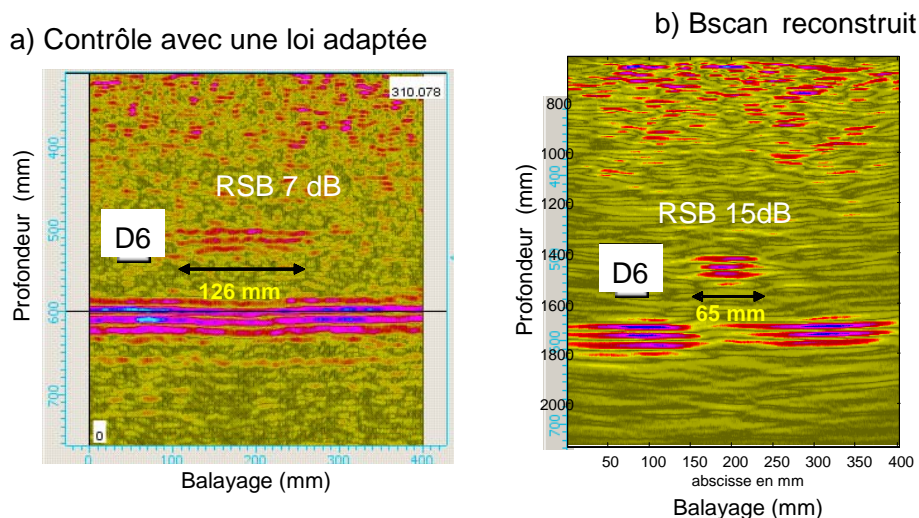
Détection d'un défaut sous ferrailage avec loi adaptée et reconstruction du bscan
